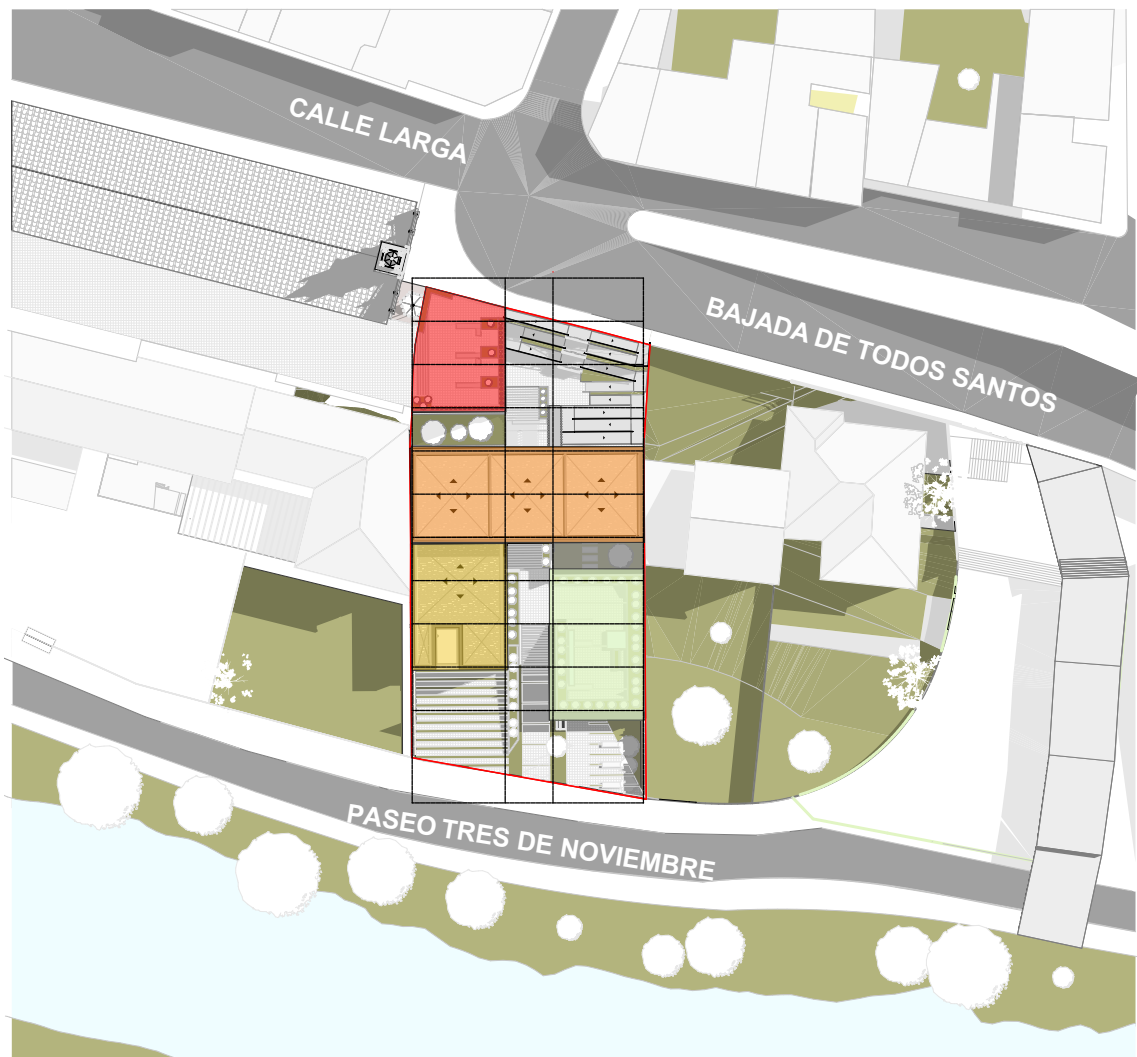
Vista en planta del bloqueamiento. Fuente: Elaboración propia.
